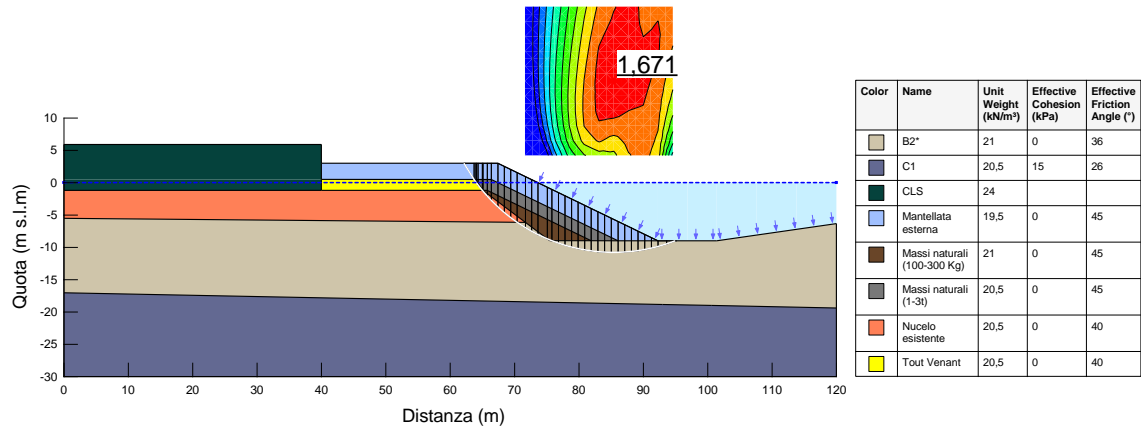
Sezione longitudinale – SLV-GEO 2 – Sisma ↓ – Superficie critica
